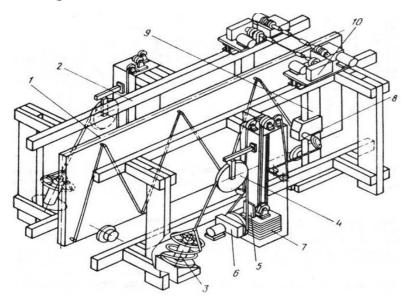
Установка преднапряженного непрерывного армирования 1 — форма; 2 — верхняя направляющая балка; 3 — бухторазматыватель; 4 -направляющий блок; 5 — упоры; 6 — привод подачи; 7 — устройство для натяжения проволоки; 8 — пиноль; 9 — балкатраверса; 10 — механизм перемещения балки-траверсы
